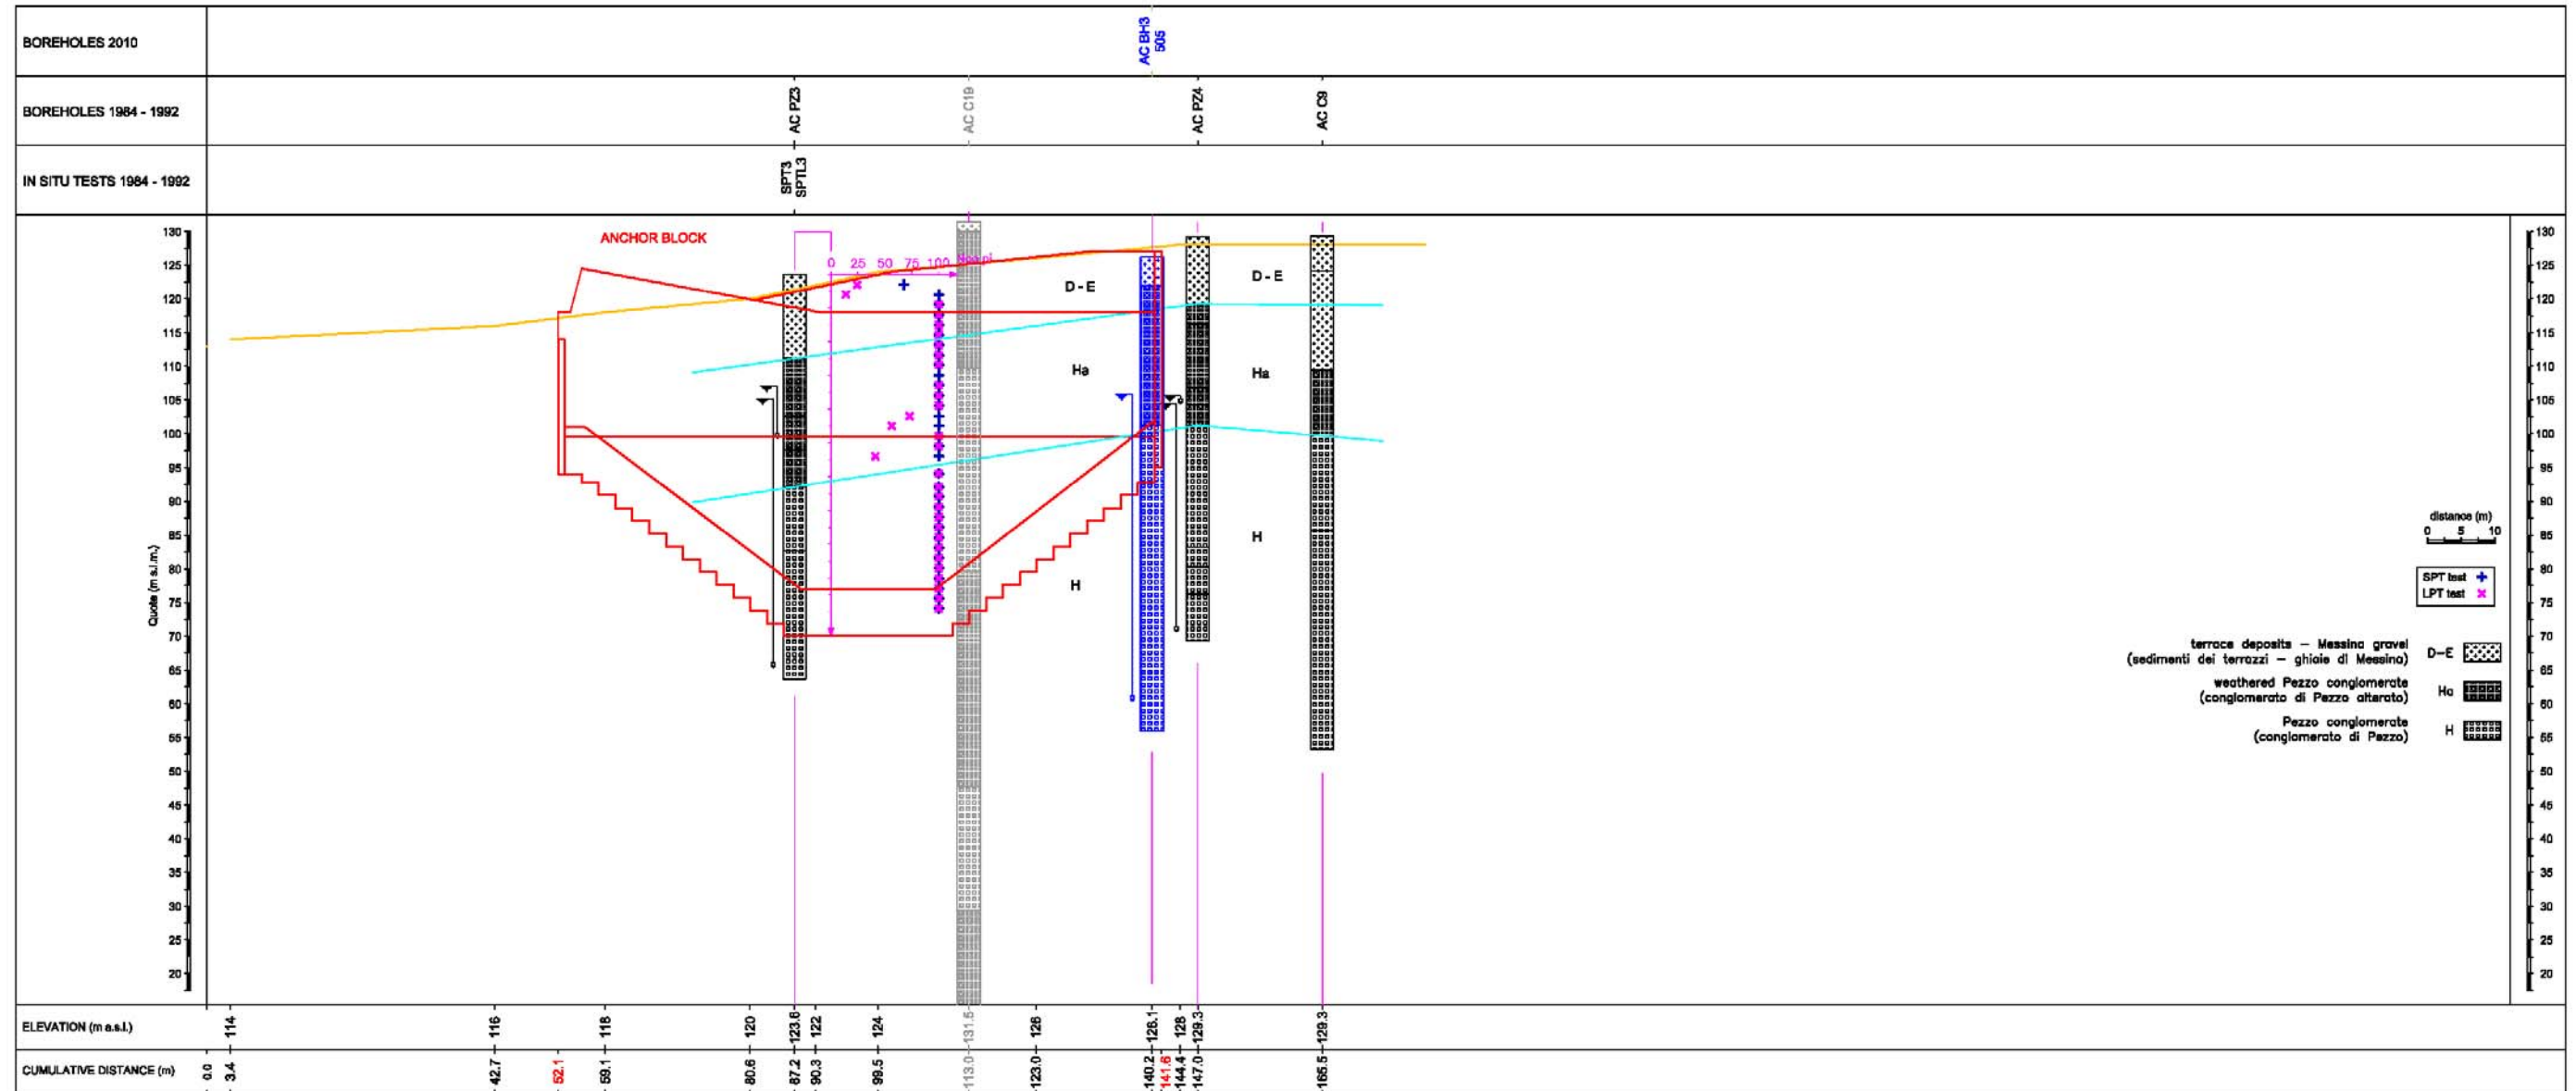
Blocco di Ancoraggio Calabria, sezione trasversale N. 2
